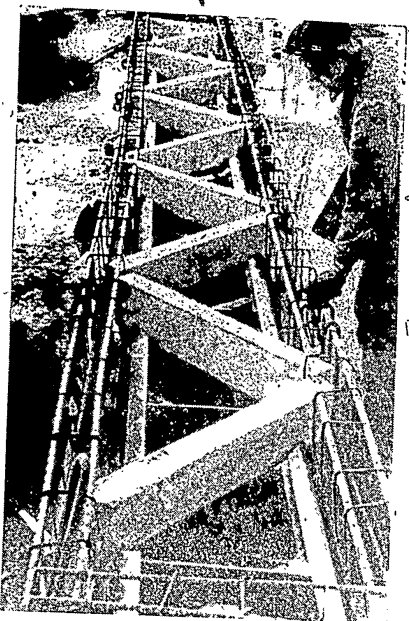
Армирование колонн и укладка струбетонных брусков решетки.
